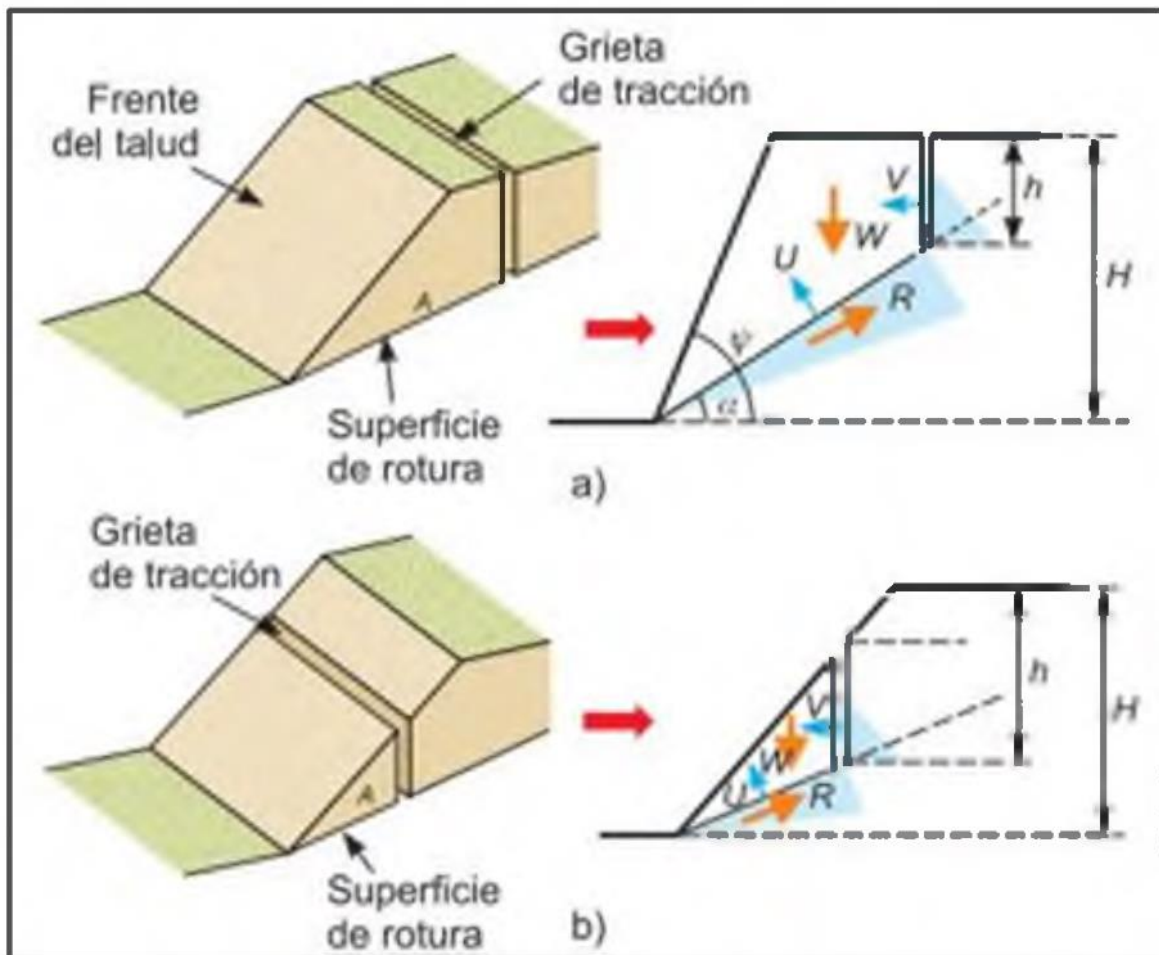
Geometría de la rotura plana en talud. a) Grieta de tracción en cabecera, b) Grieta de tracción en la cara del talud. (Vallejo 2004, modificado de Hoek y Bray, 1981)
